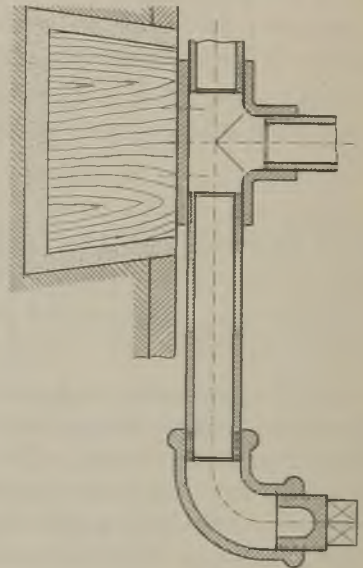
Wasserjack für Gasleitung. Schnittzeichnung.
